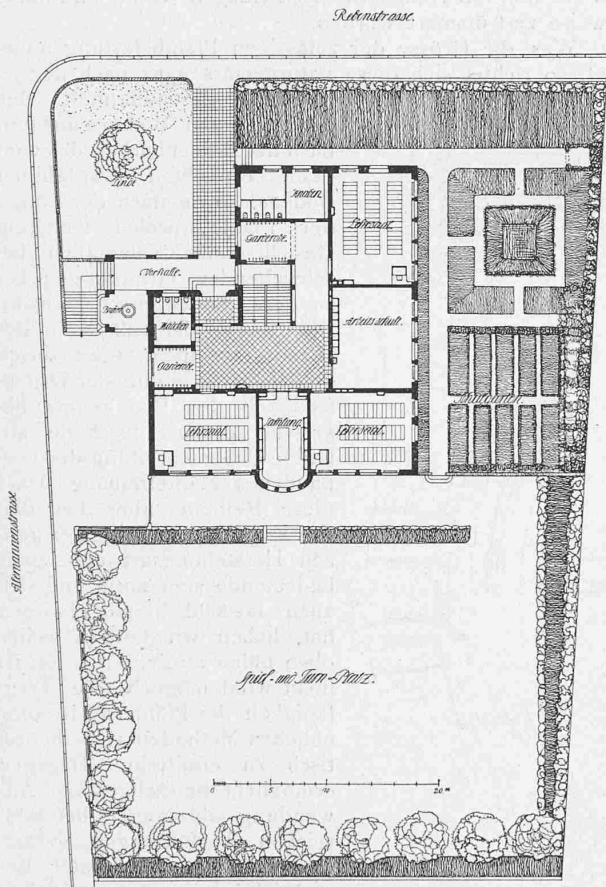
Lageplan und Erdgeschoss-Grundriss. — 1 : 600.
